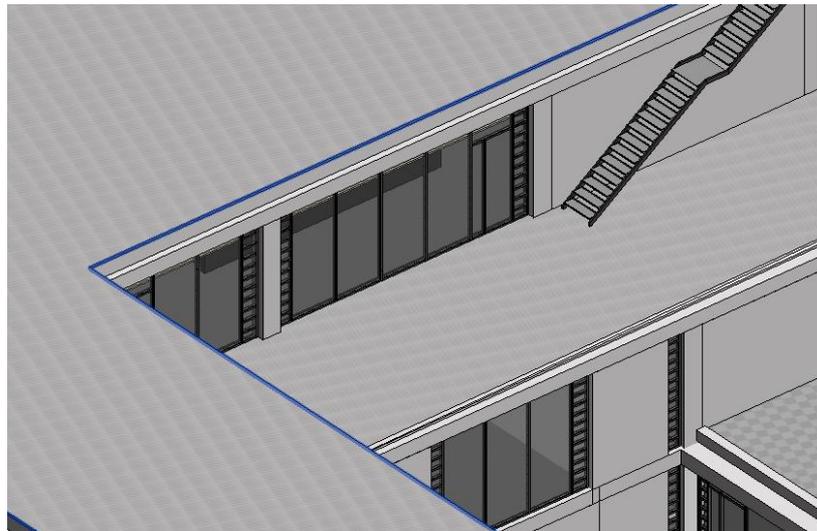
Vista 3D con muros cortina completos. Fuente: propia
